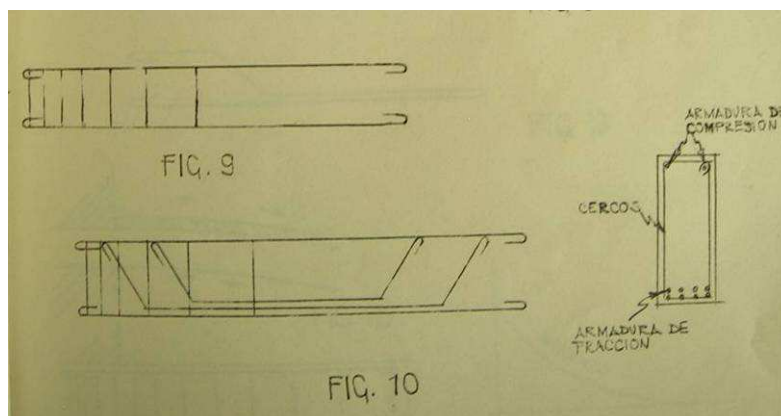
Despiece armadura de cortante en vigas, (IccET, 1954).
